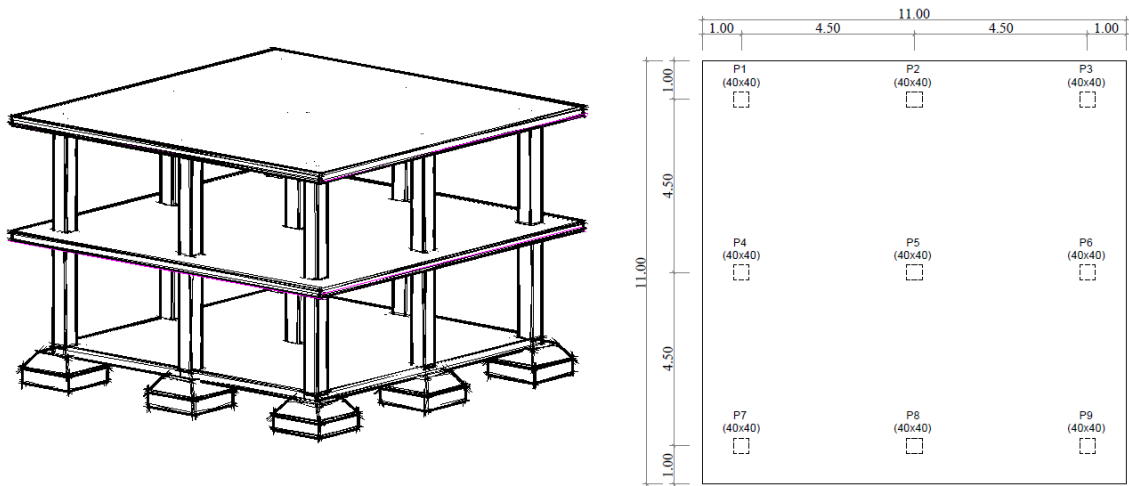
Perspectiva e planta baixa da laje lisa sem armadura de cisalhamento estudada
